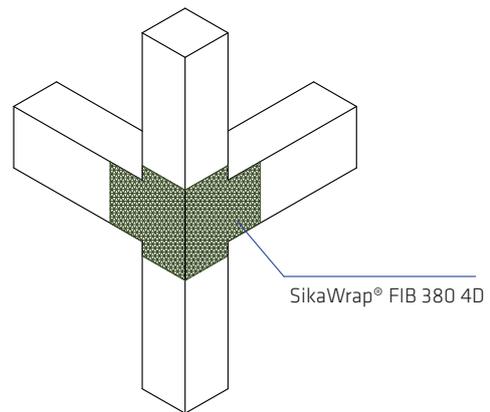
Fase 2: Rinforzo con fasce quadriassiali per pilastri d'angolo e pilastri perimetrali intermedi
